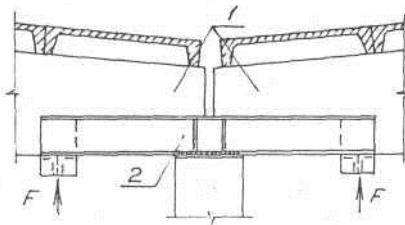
(1 — усиливаемые балки, 2 — двухконсольная балка)
